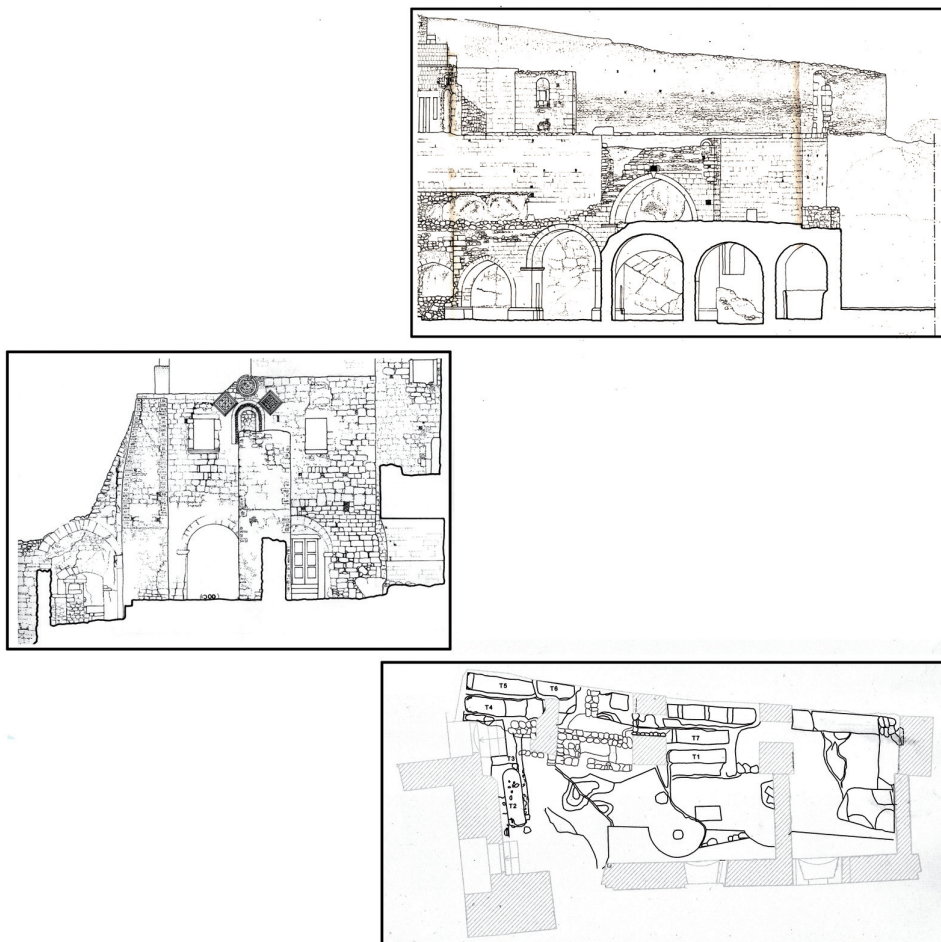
Settore III. Sezione degli ambienti a3 – a5 e prospetto della struttura ad arcate CA1 in basso a sinistra (Archivio SAR Puglia).
